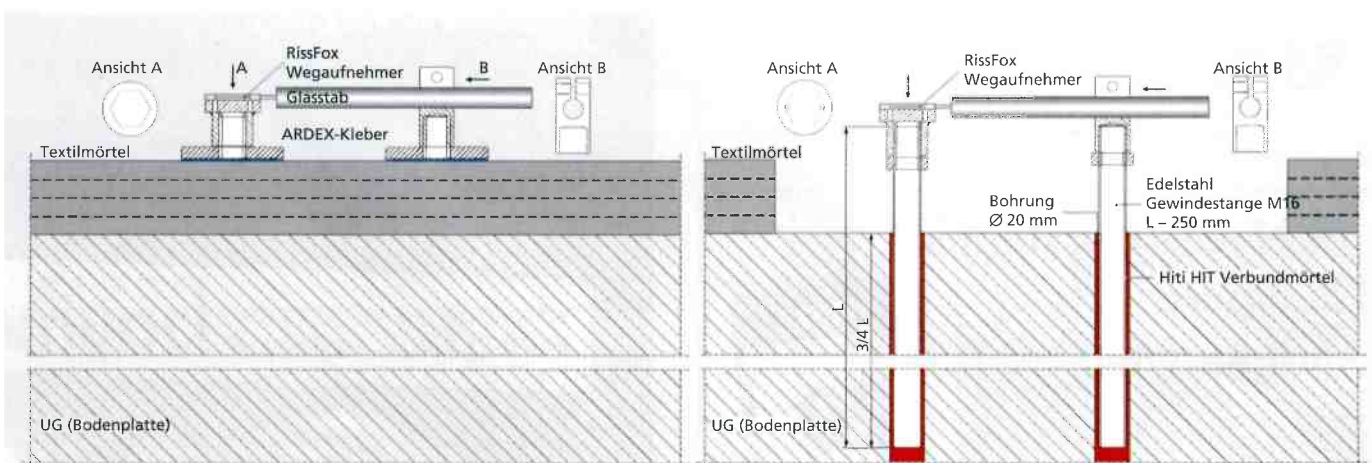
Installierte Rissensoren auf dem Rohbeton und auf der Carbonbetonschicht
